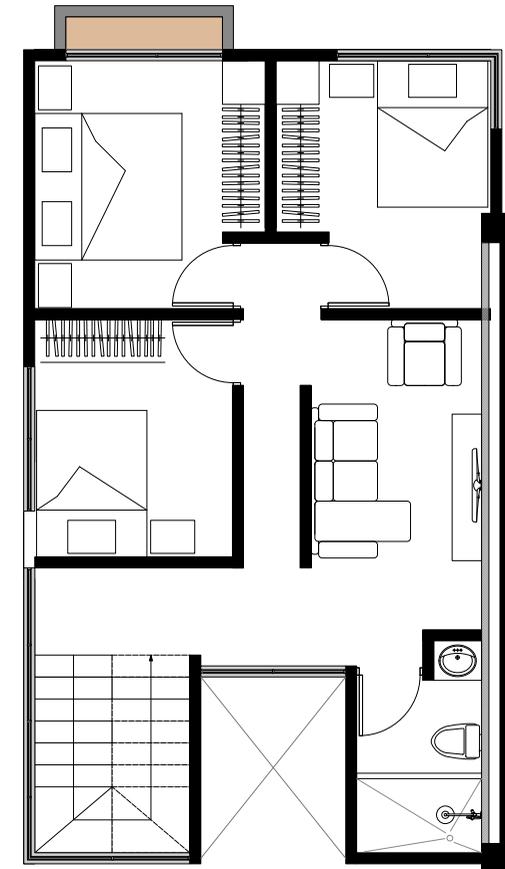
Diagrama Distribución Arquitectónica Módulo Vertical Tipo A
